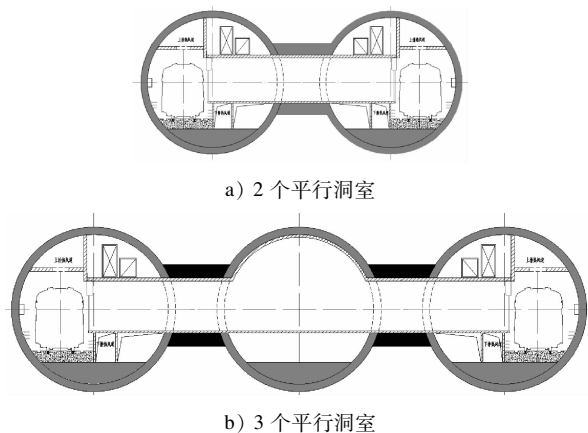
采用“盾构+横通道”施工的地铁车站横断面布置图
